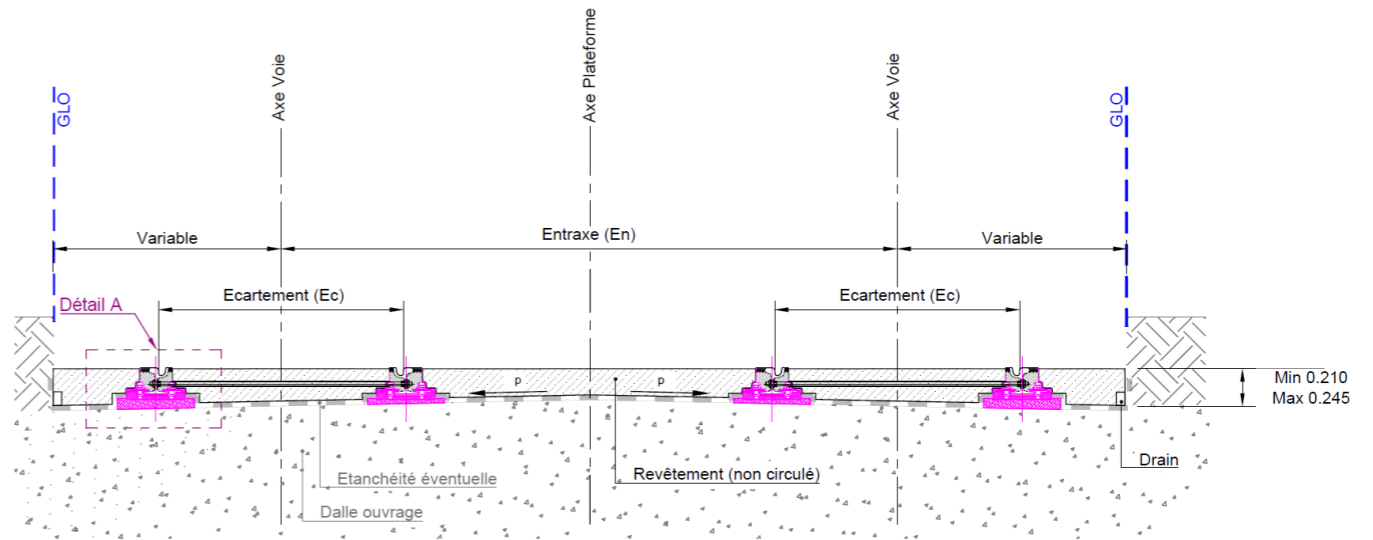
coupe type d'une plateforme pour voie sur selles collées par résine sur ouvrage
